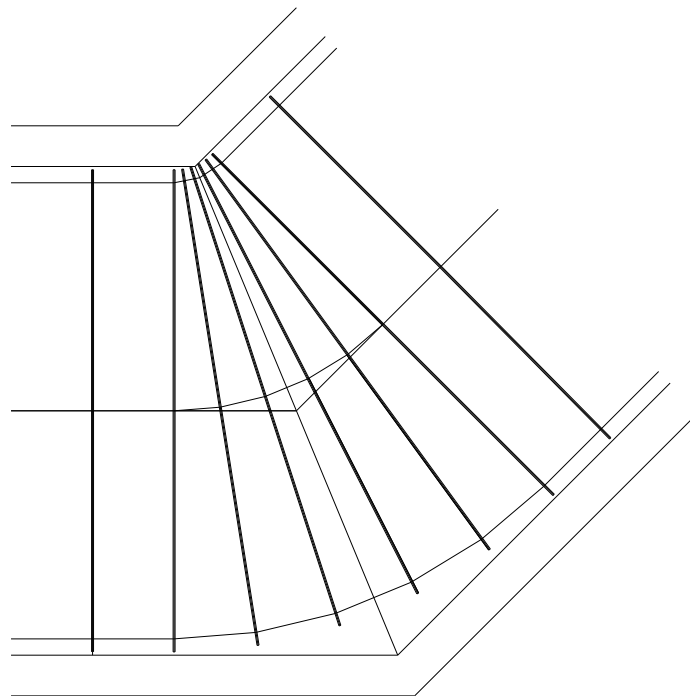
屈曲部鋼製リング組立て平面図 (φ1,500 mm 実績)
